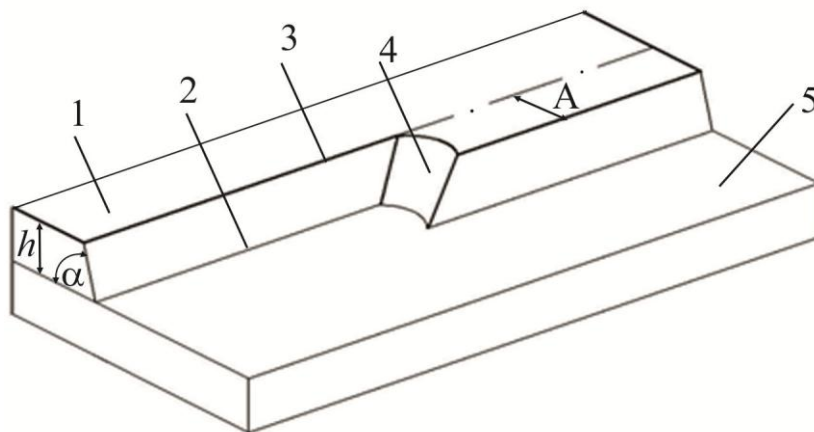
Схема уступа: 1 – верхняя площадка уступа; 2 – нижняя бровка уступа; 3 – верхняя бровка уступа; 4 – торец уступа; 5 – нижняя площадка уступа; α – угол откоса уступа; h – высота уступа; A – ширина заходки
